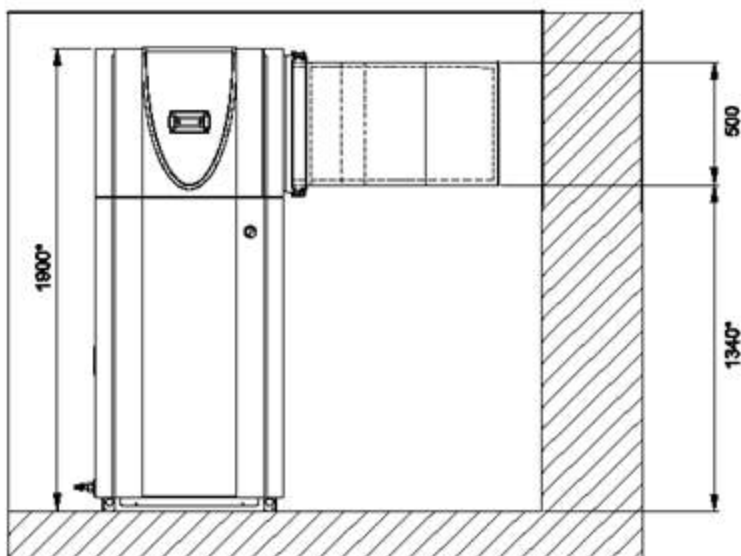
Vue de face - LIK 8TES (installation murale - conduit d'air, côté refoulement)
